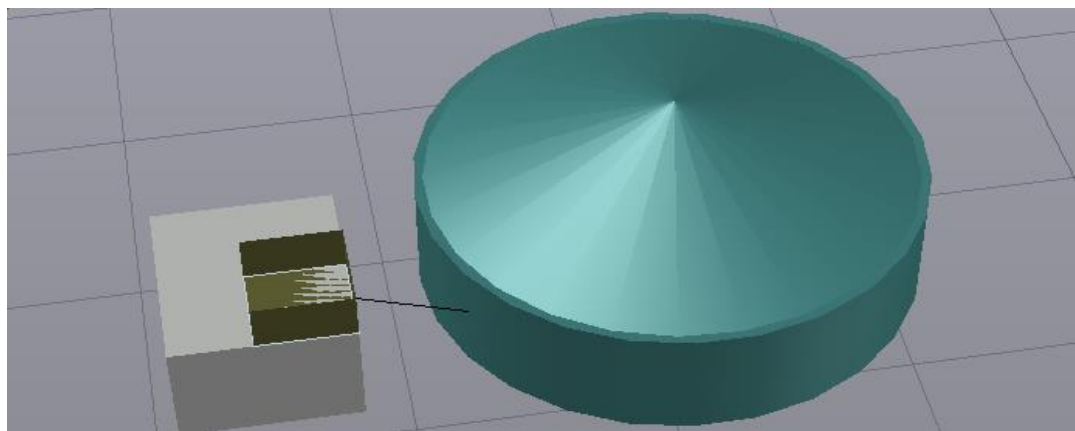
Conexión del tanque de ensilaje y el digestor. AutoCAD 3D. Fuente: Elaboración propia
